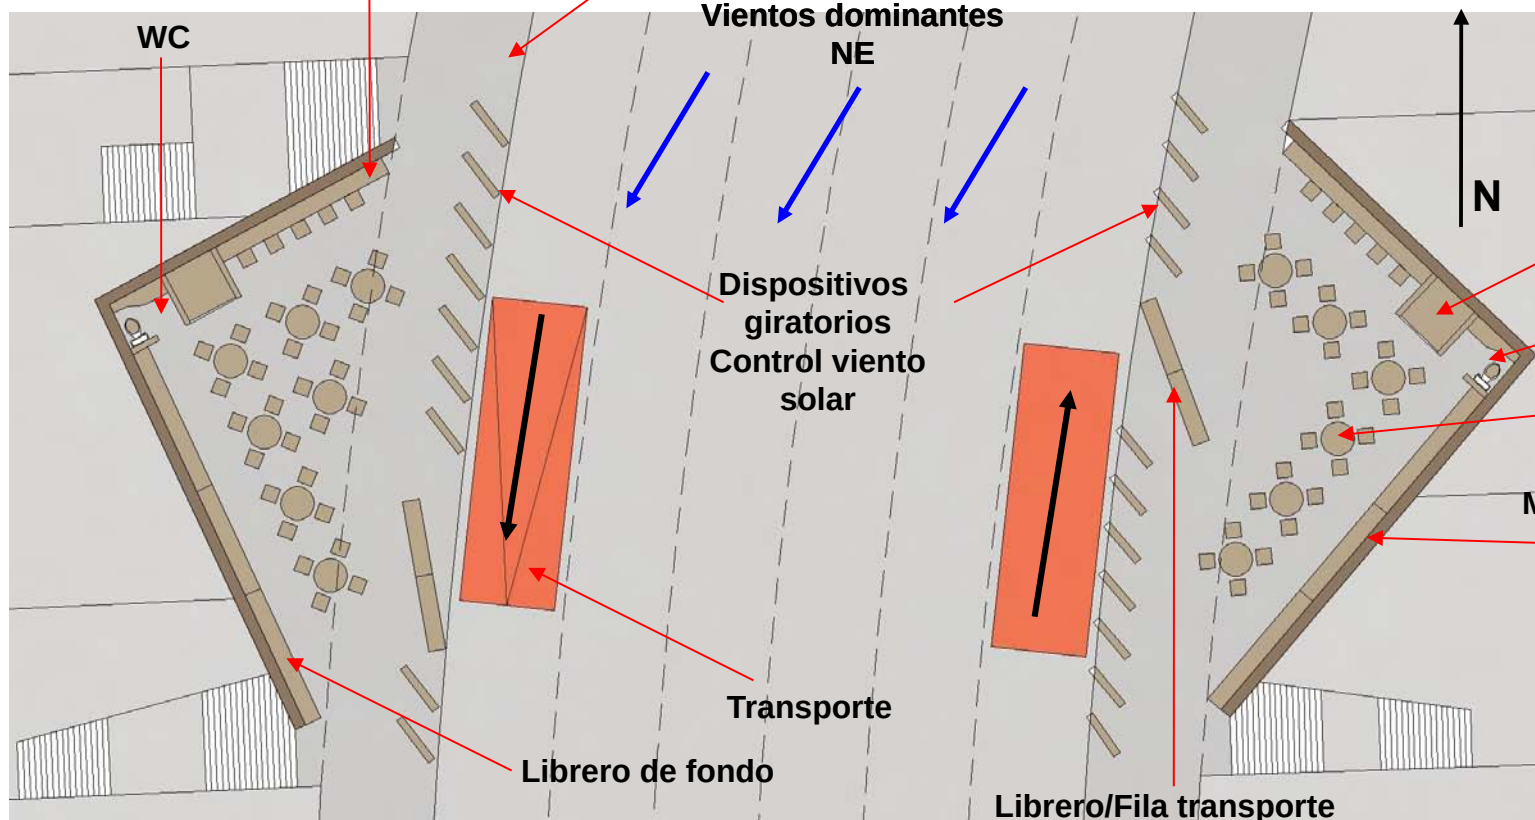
Vistas y planta arquitectónica Estación de Transporte - Biblioteca
